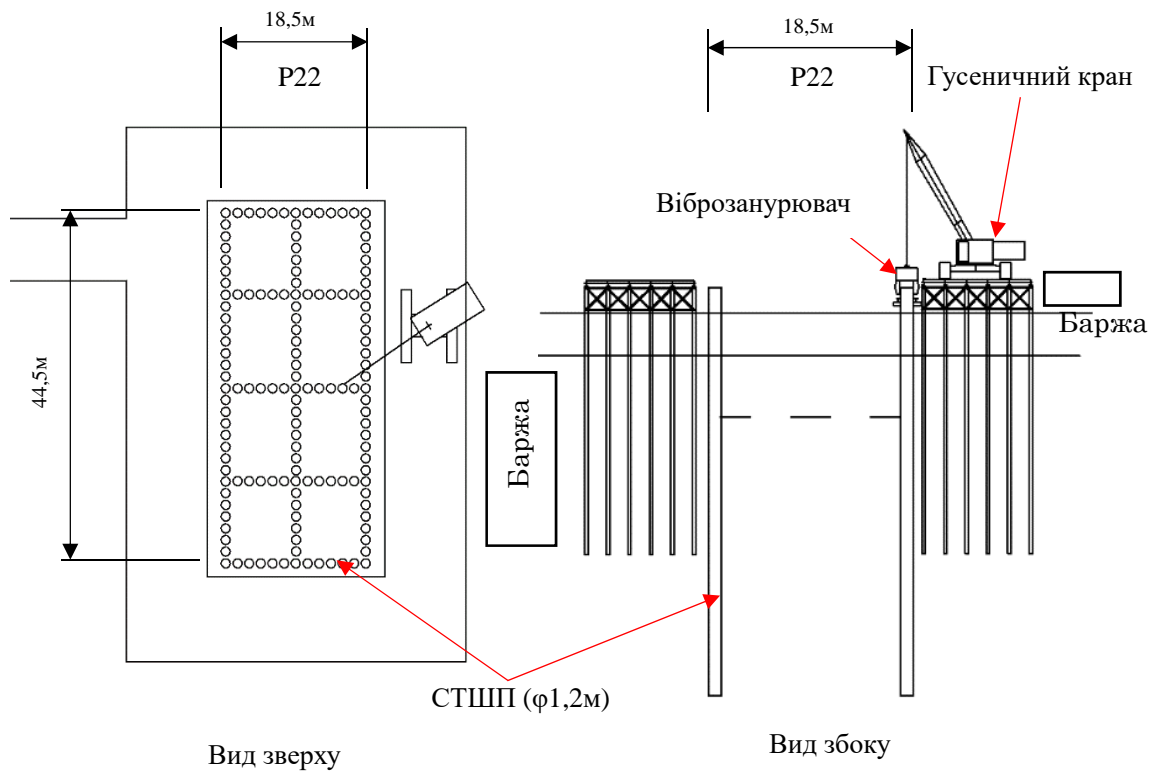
Довідкове креслення для будівництва фундаменту зі сталеві трубчастої палі на P22
